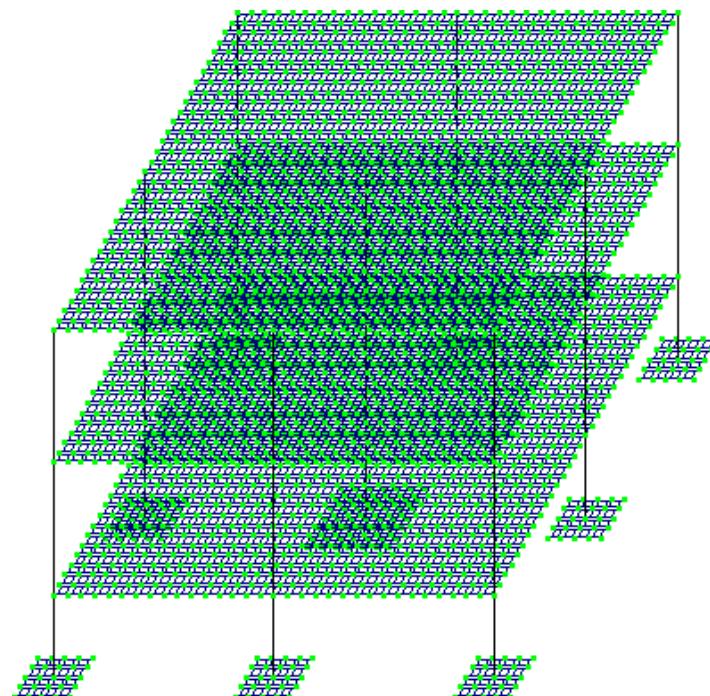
Просторова модель будівлі до підсилення з існуючими фундаментами
